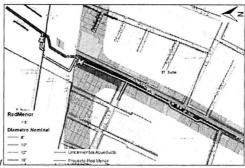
Redes acueducto existentes y proyectadas. Fuene: SIGUE EAAB
